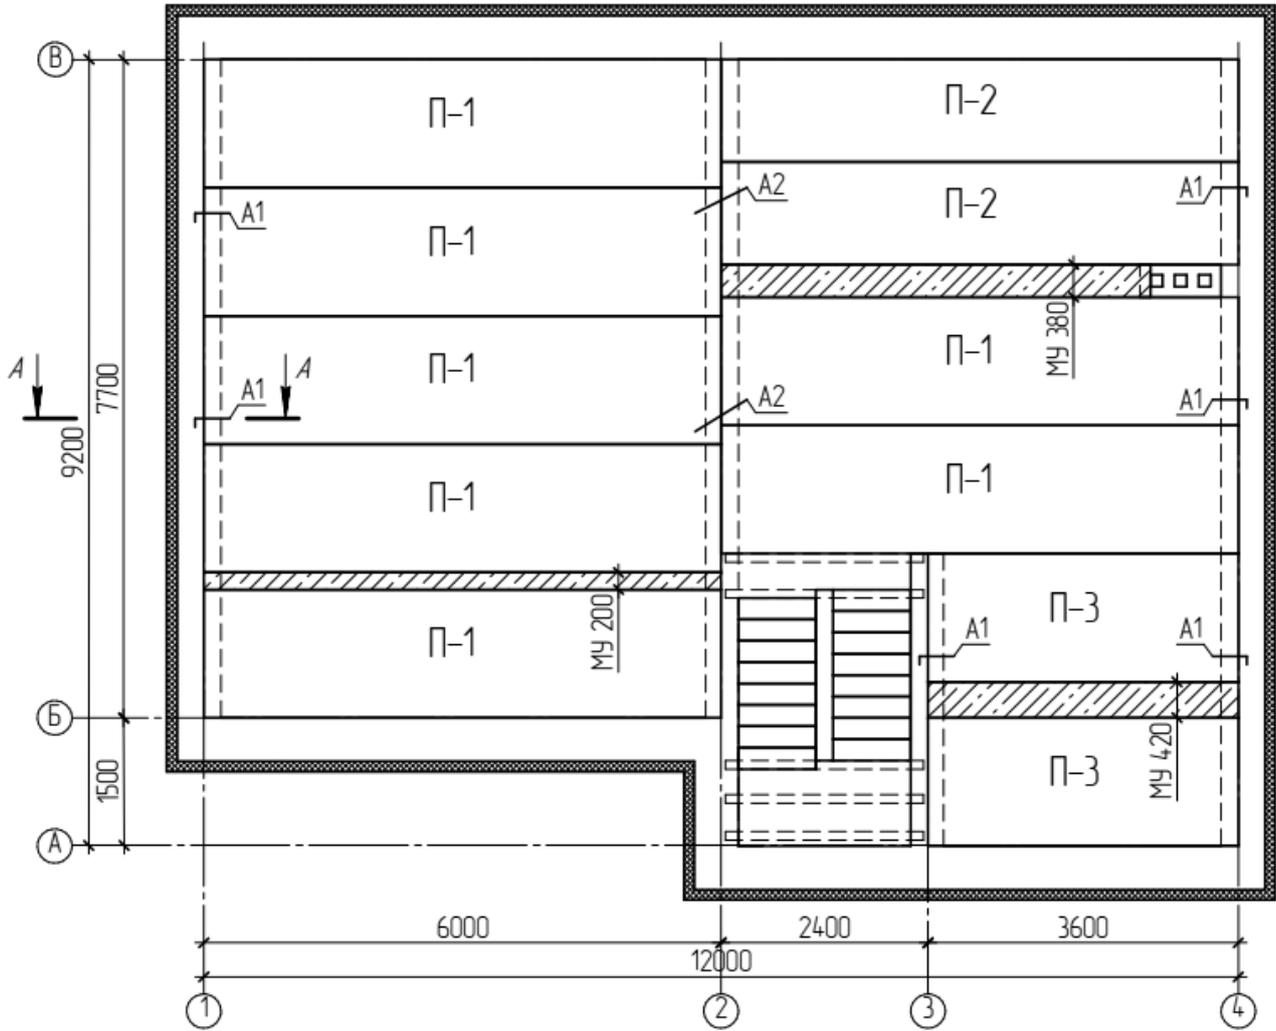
Пример выполнения схемы расположения элементов перекрытия
